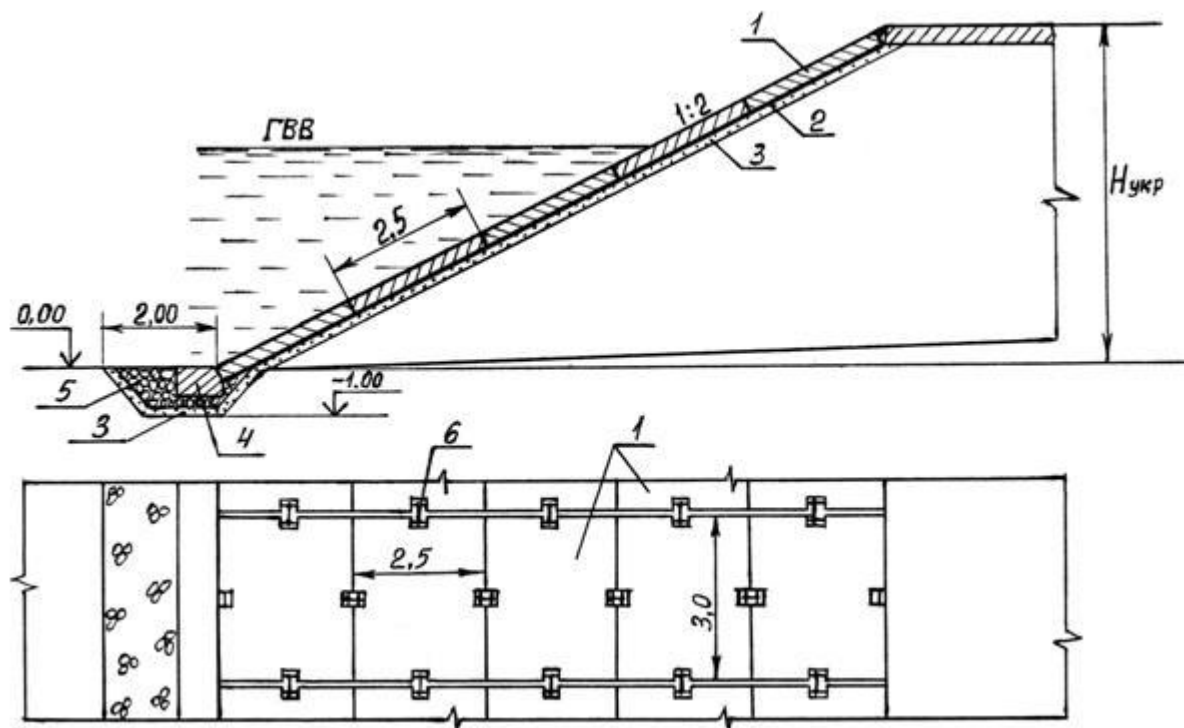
Укрепление откоса сборными железобетонными плитами:
